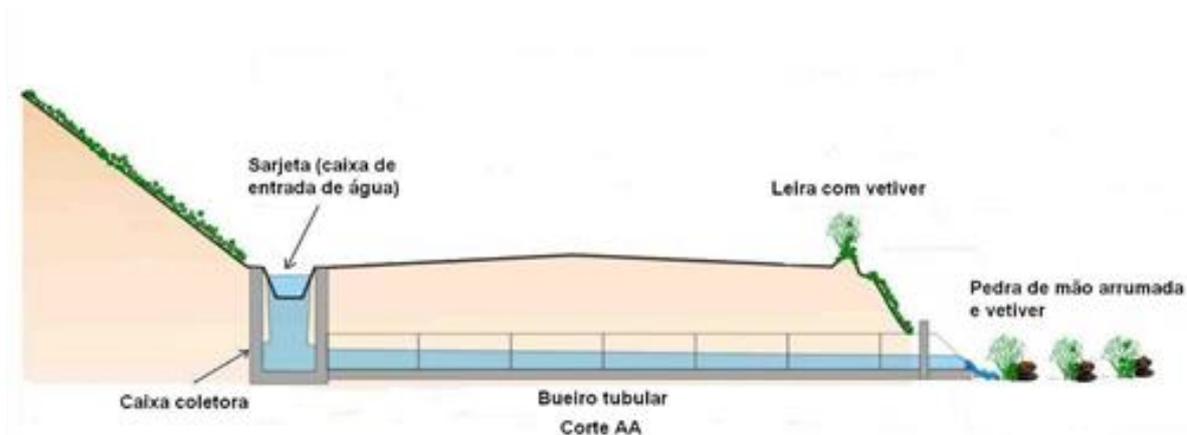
Imagem e desenho esquemático para a proteção de saídas de bueiros (sem escala) (Fonte: Elaboração própria)
